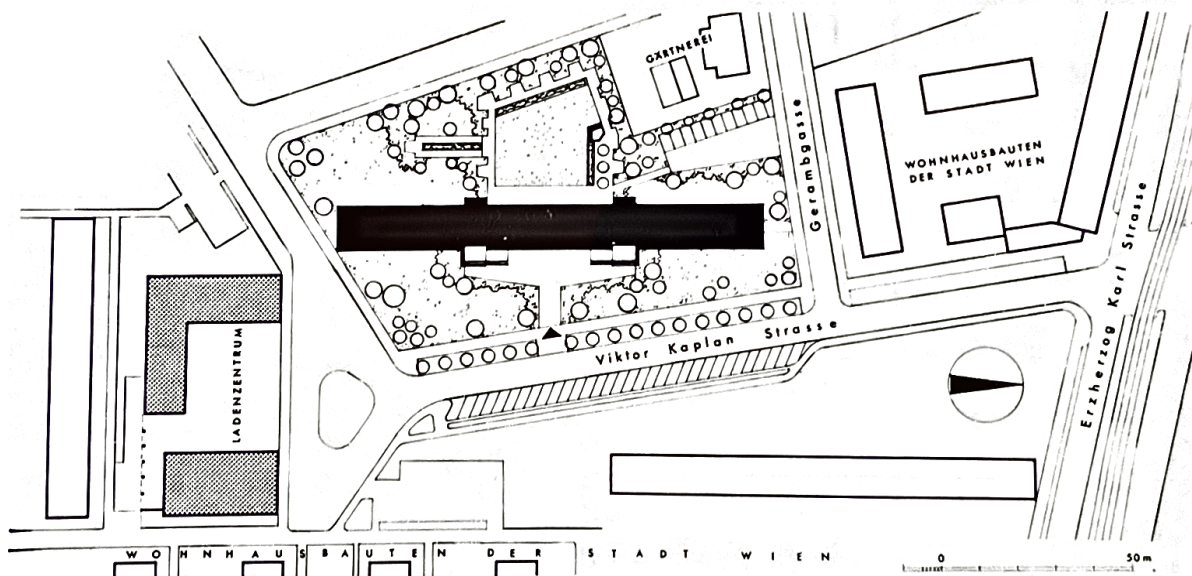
Edith Lassmann, Haus Sonnenhof, Lageplan, 1963, Wien.
